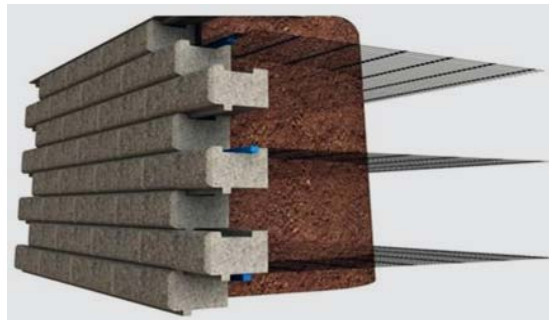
Aufbau einer geogitterbewehrten modularen Betonwand
